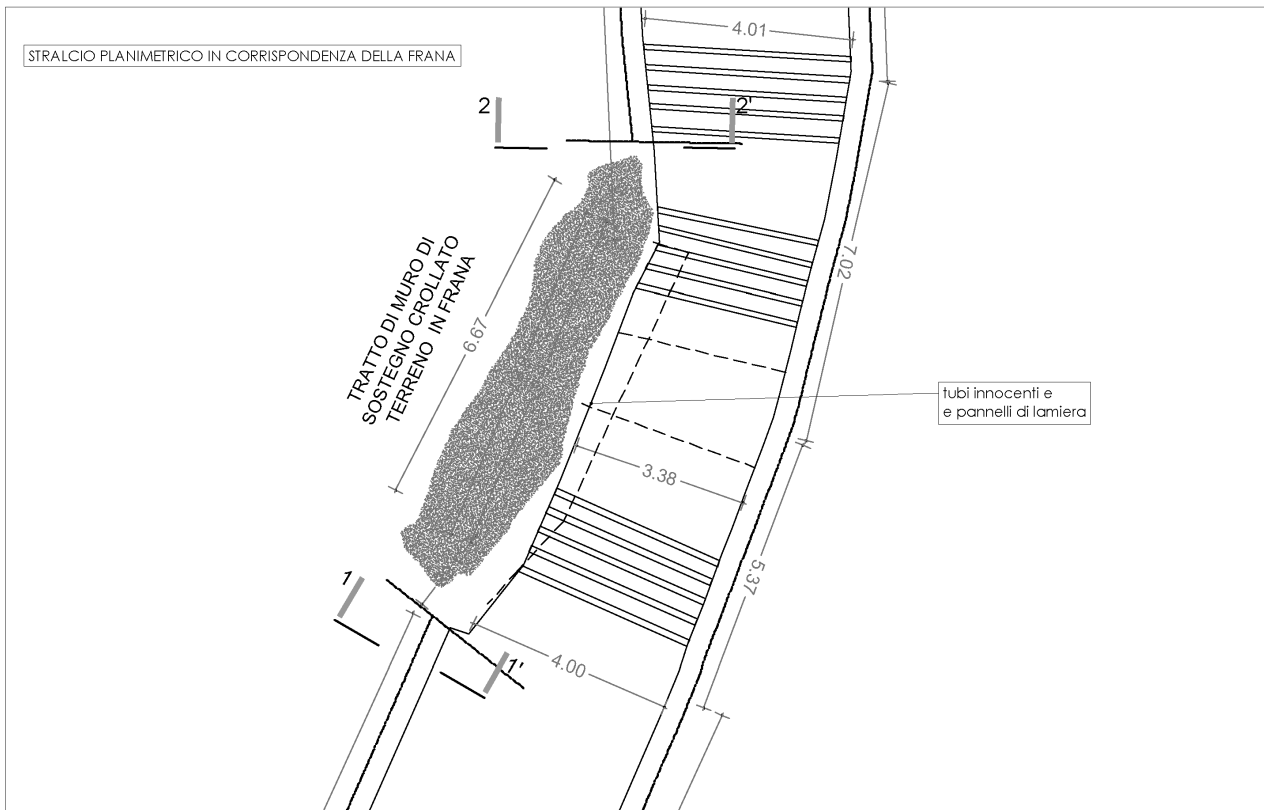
stralcio planimetrico in corrispondenza del muro crollato
